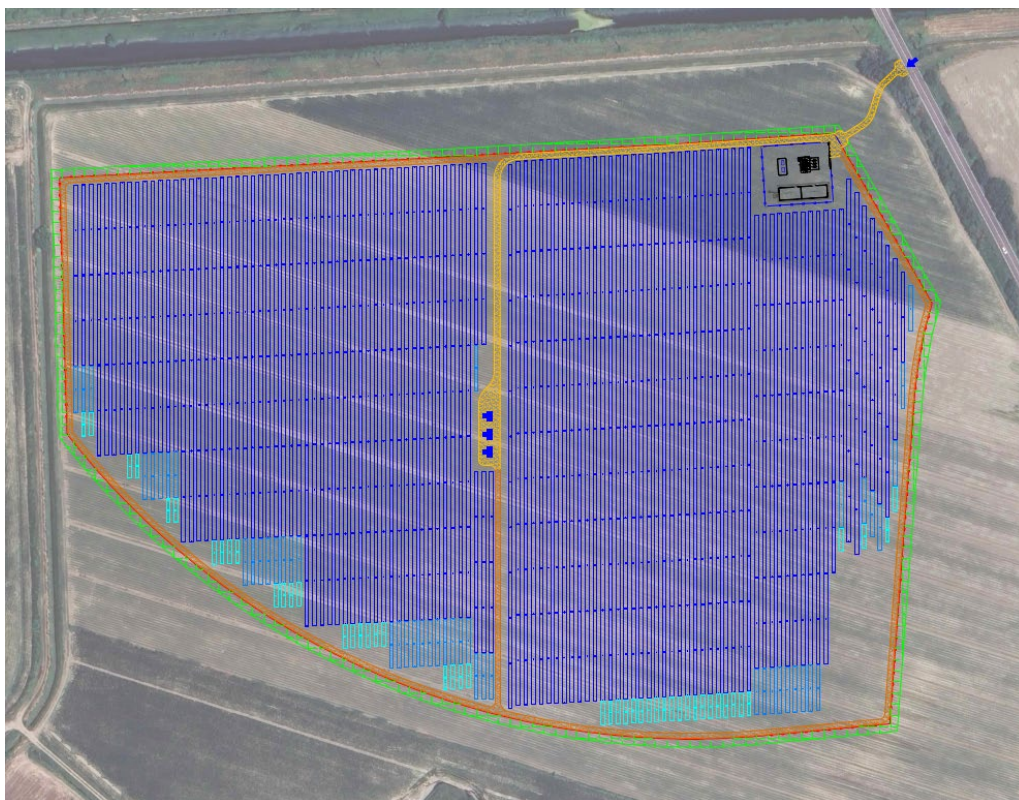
Inquadramento su ortofoto del layout di impianto.
